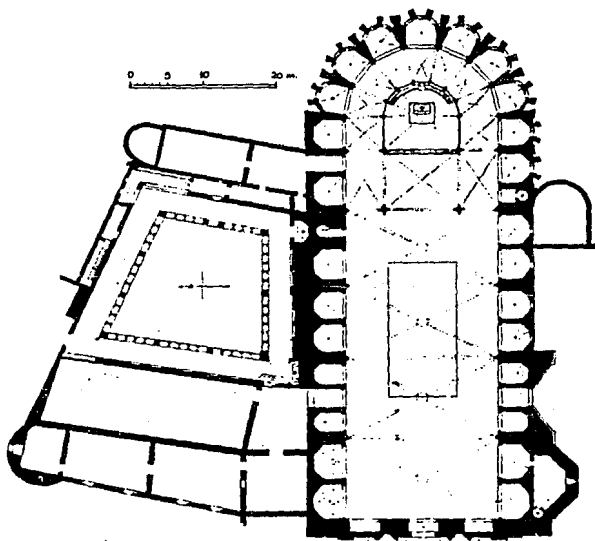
PLANTA DE LA CATEDRAL DE GERONA.
